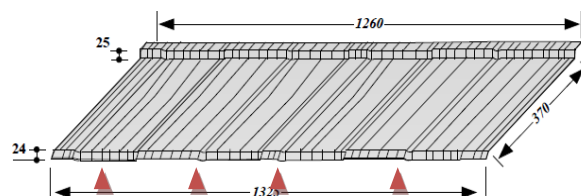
METROTILE® WOODSHAKE dakpan - plaatsing van de bevestigingen
